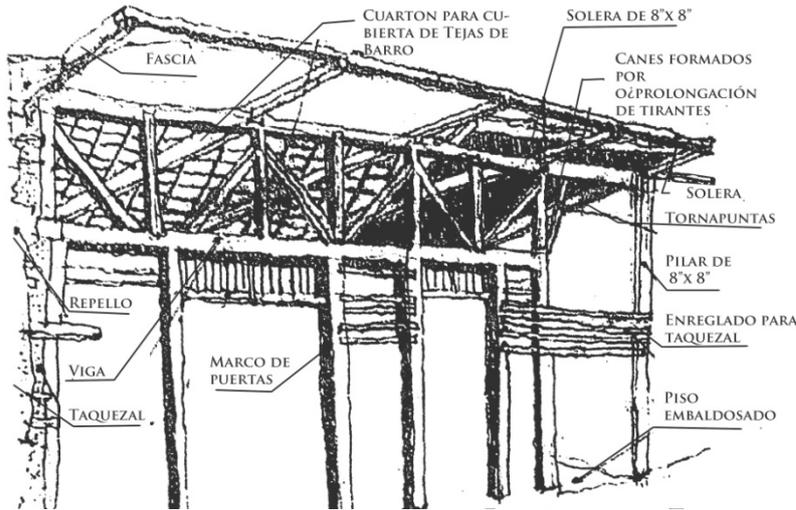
ESTRUCTURA DE TAQUEZAL
